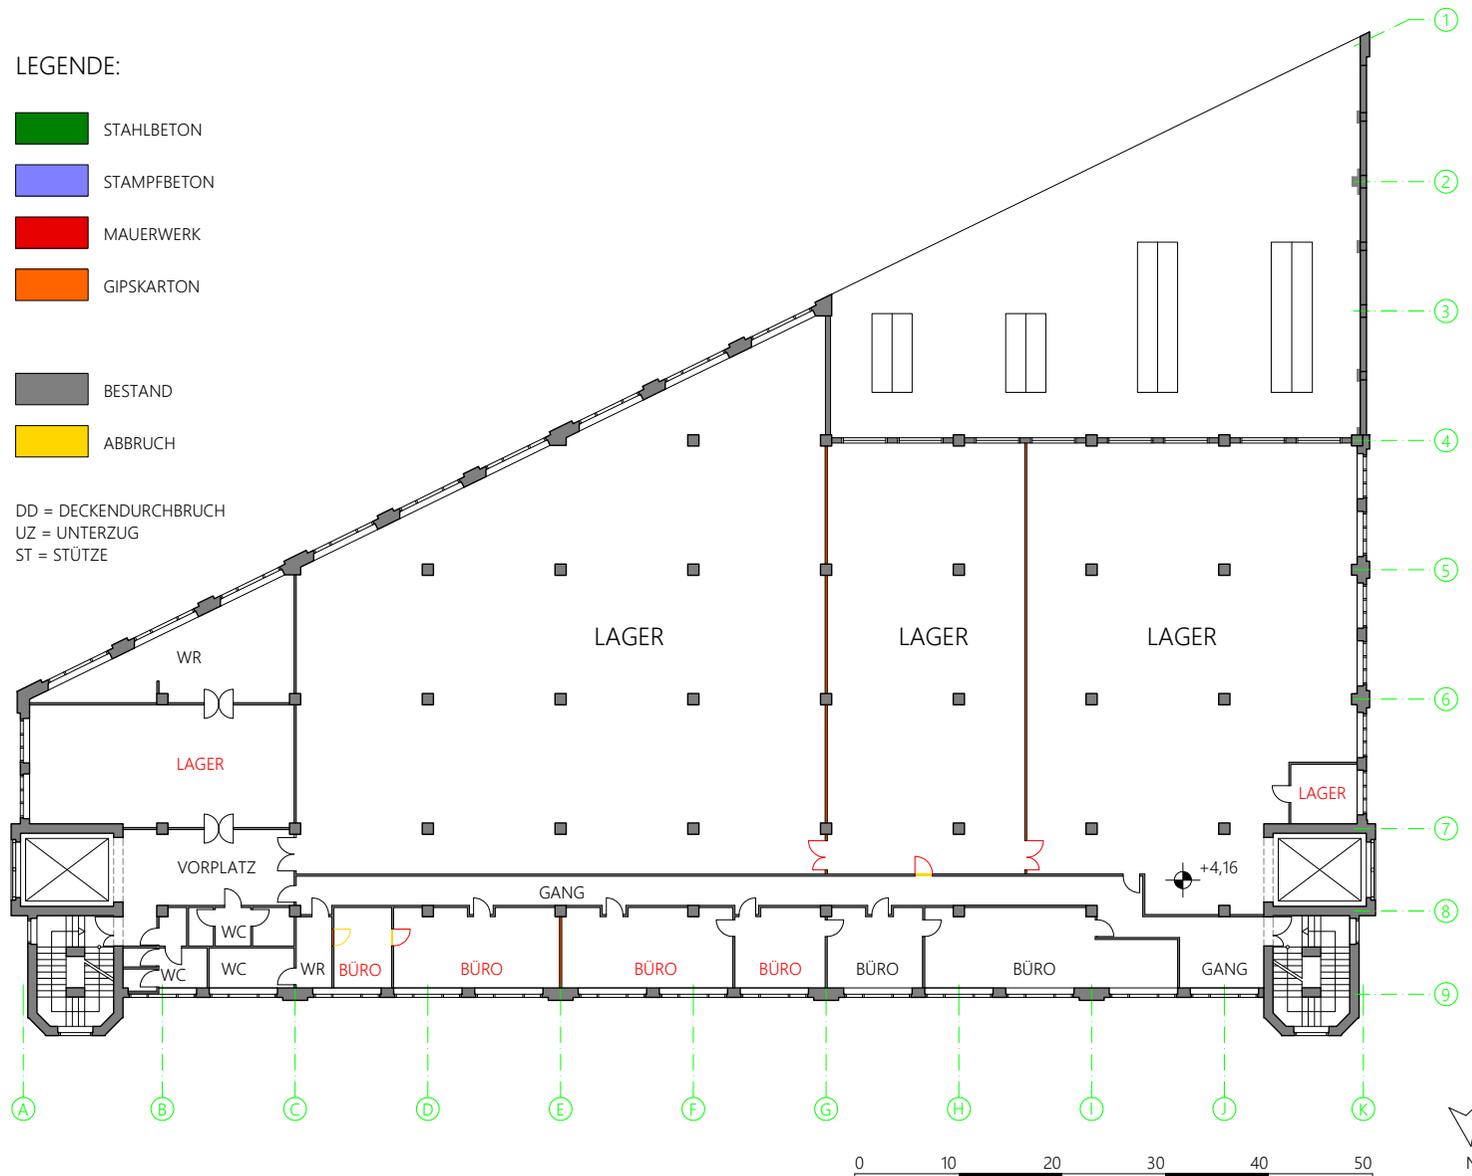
Bauphasenplan 2008: Erstes Obergeschoß des Maschinenmagazins
